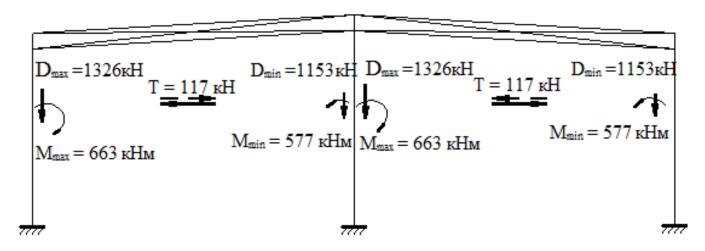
(a) Схема приложения крановых нагрузок №1: кран находится вблизи колонны А пролета АБ, и вблизи колонны Б пролета БВ.
